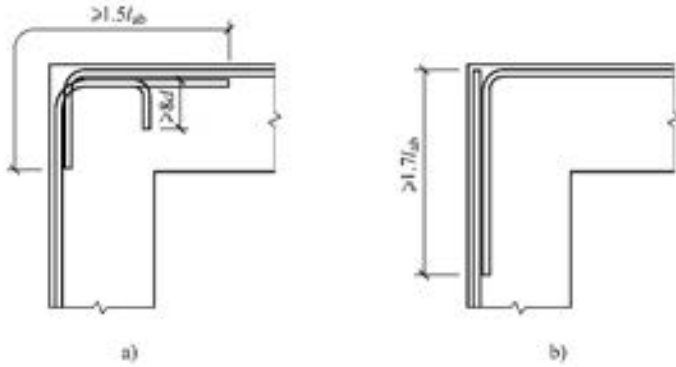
顶层端节点梁、柱纵向钢筋在节点内的锚固与搭接
